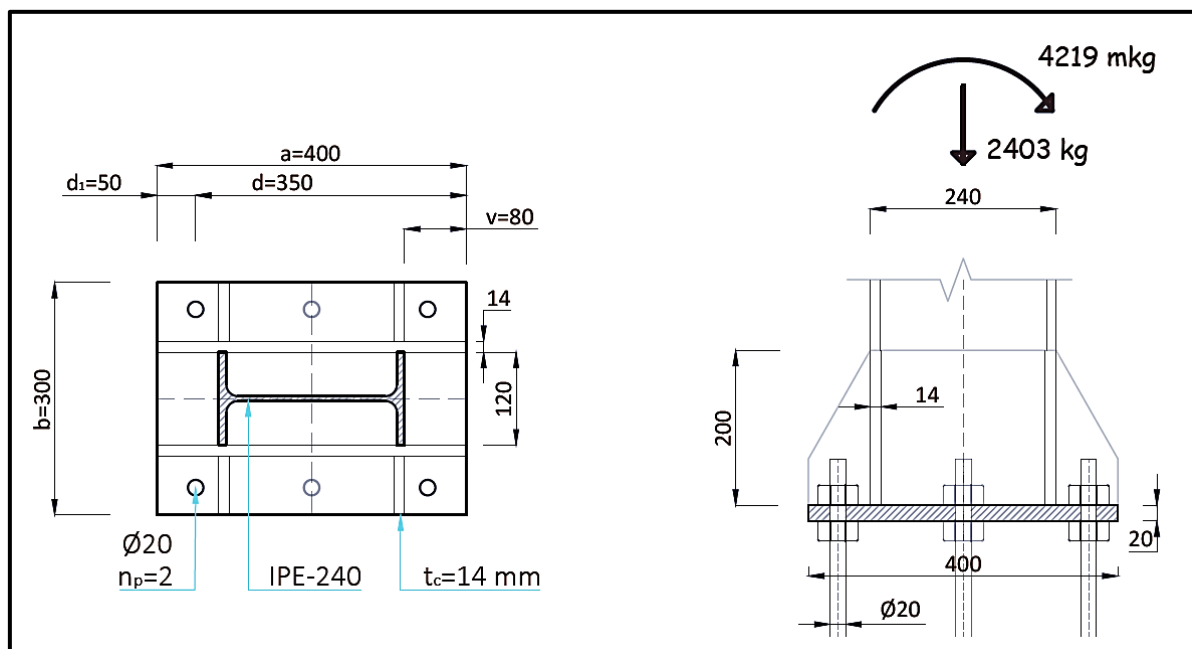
Dimensiones de la placa de anclaje para pilar IPE-240.
